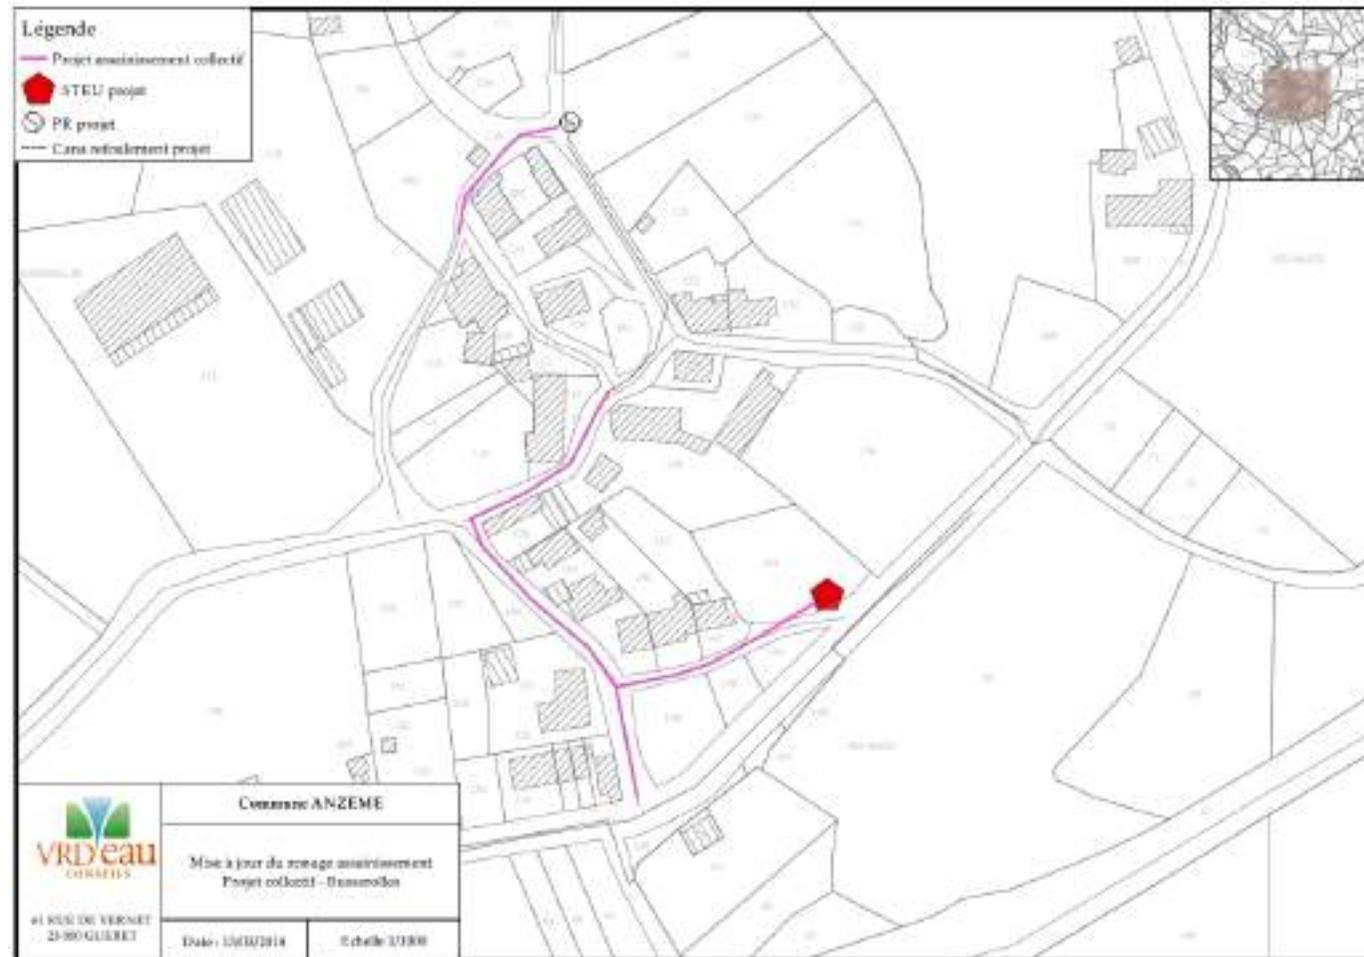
projet d'assainissement collectif sur le village de Busserolles
